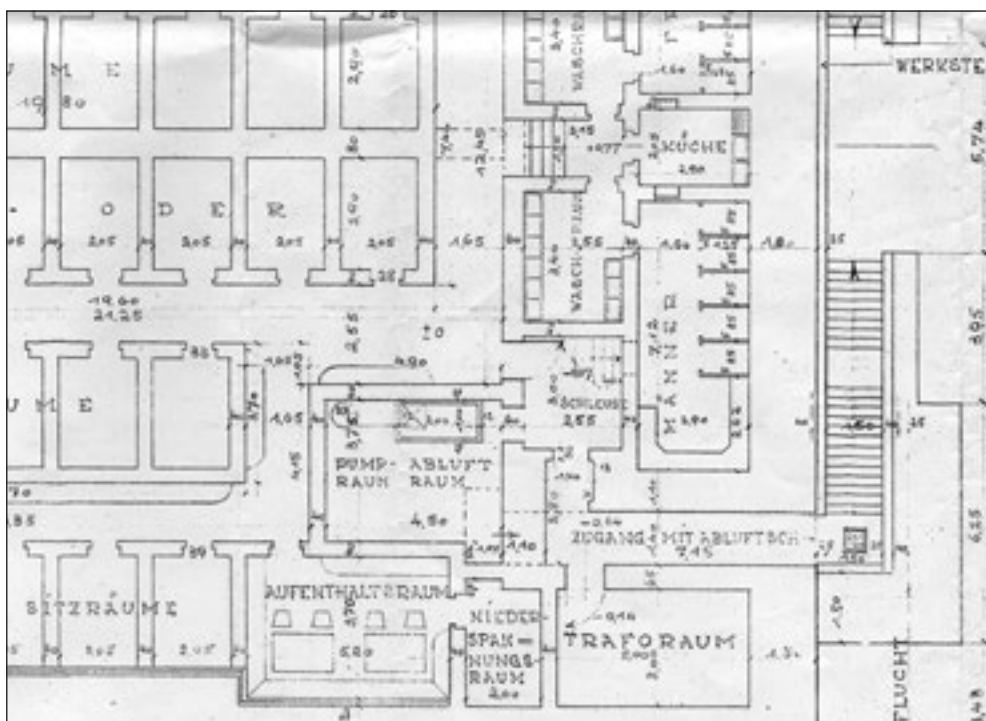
Ausschnitt aus der Grundrisszeichnung für den „LS (Luftschutz) Sonderbau Blumenplatz“, angefertigt vom Städtischen Hochbauamt Krefeld am 20. Januar 1941. Er zeigt die nord-östliche Ecke des Bunkers mit der Zugangsschleuse, einem Teil der Technikräume, dem Zugang zu den öffentlichen Toiletten und den Bereich des späteren Bunker-Hotels.
